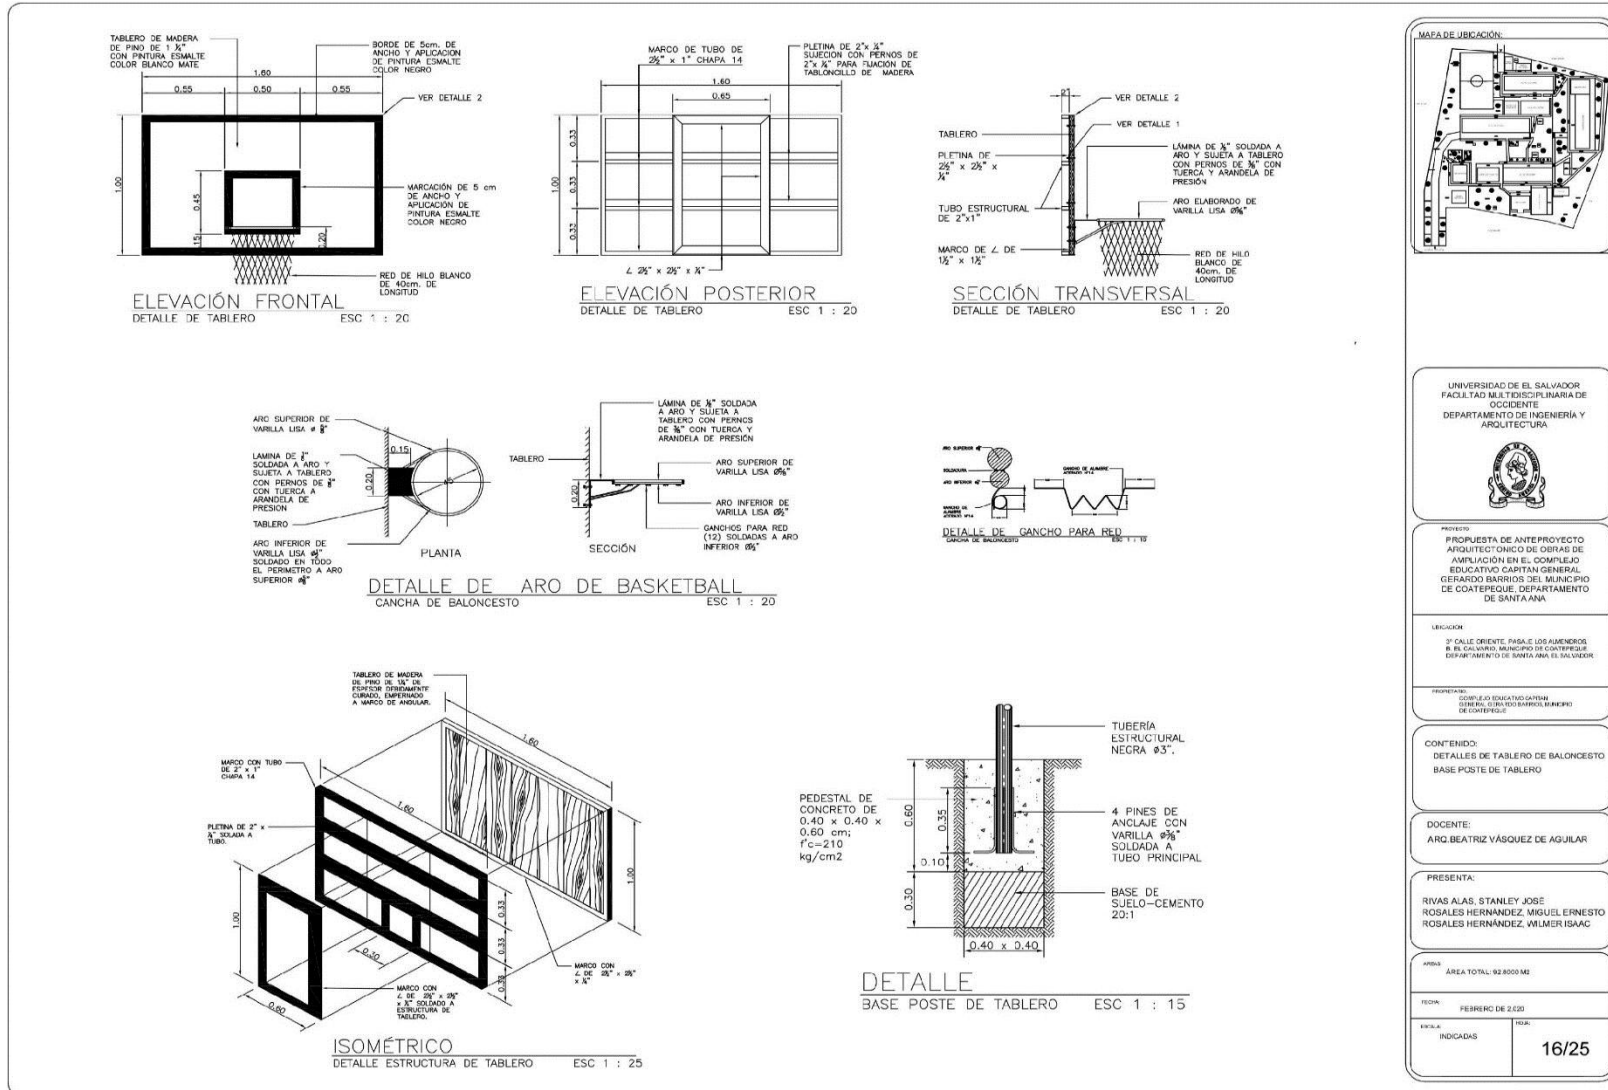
DETALLES CONSTRUCTIVOS, CANCHA DE BASQUETBOL.
